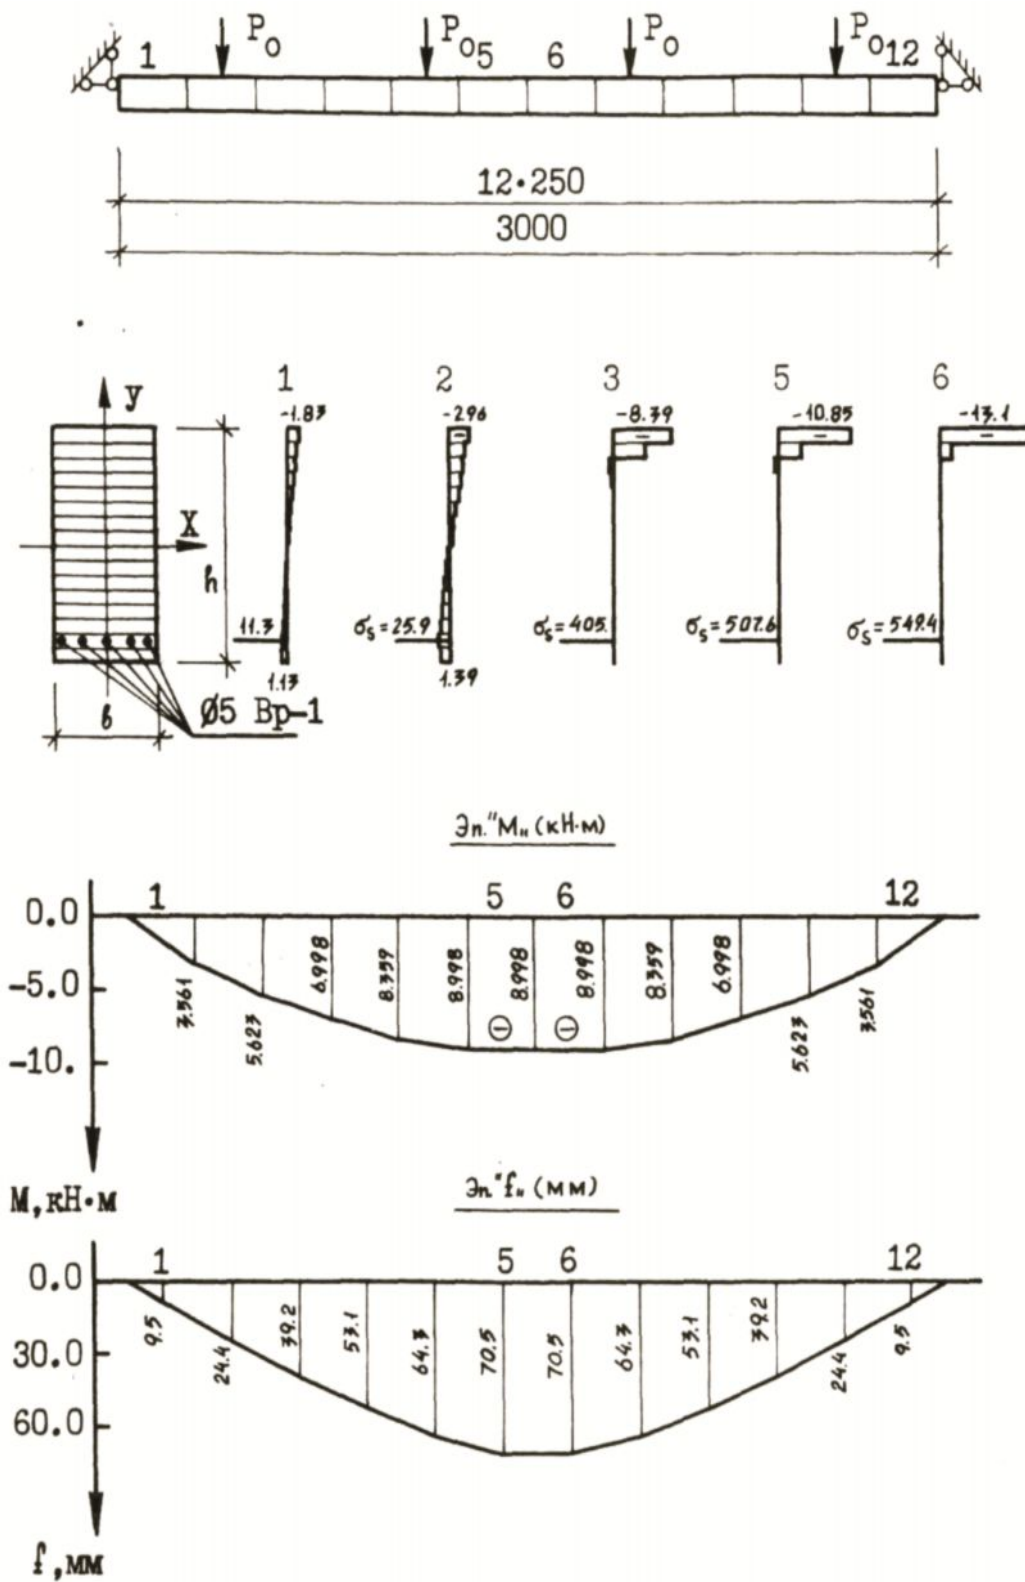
Эпюры напряжений, моментов и прогибов сборных железобетонных плит перекрытий ($e=h/4$ и $P_0=5.5$ кН)
